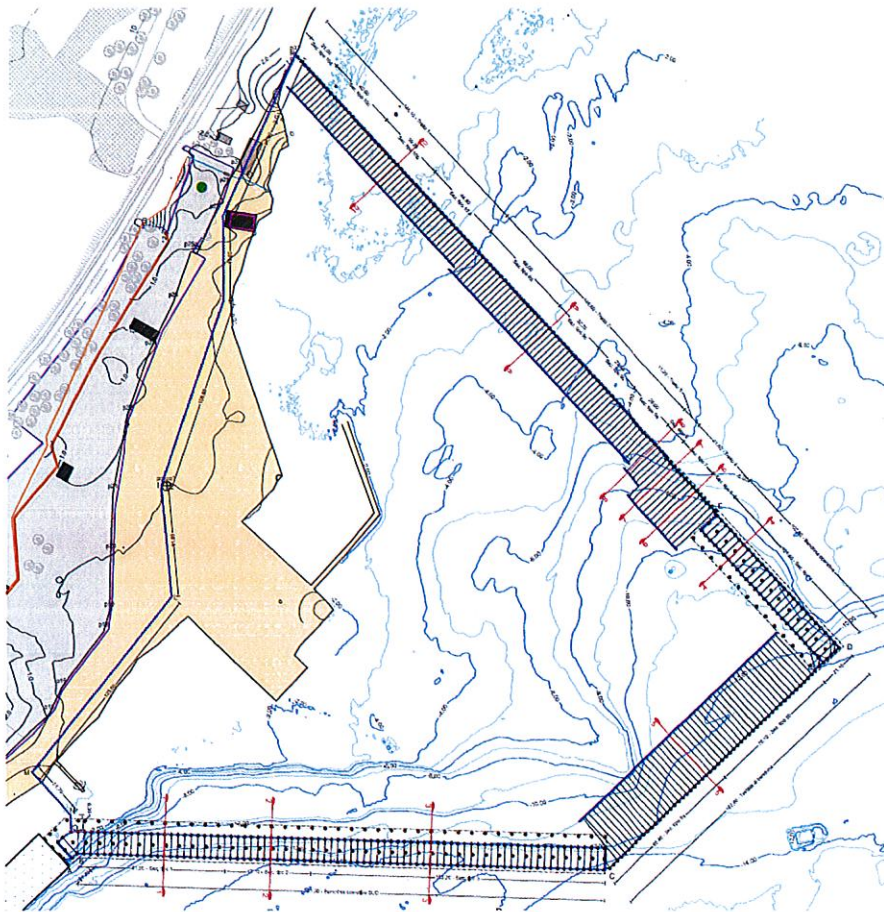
Planimetria generale con indicazione delle sezioni tipo
